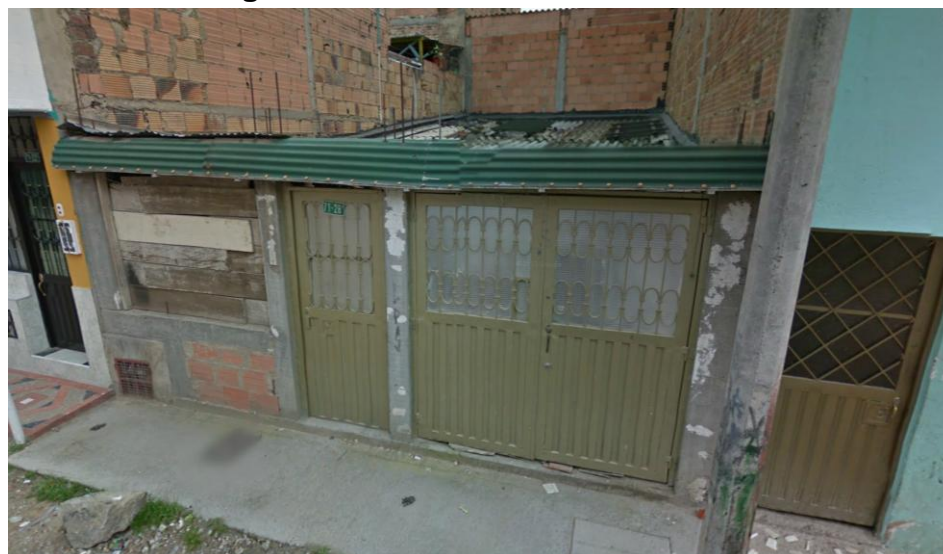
Viviendas en construcción UPZ 87 -Tintal Sur-
